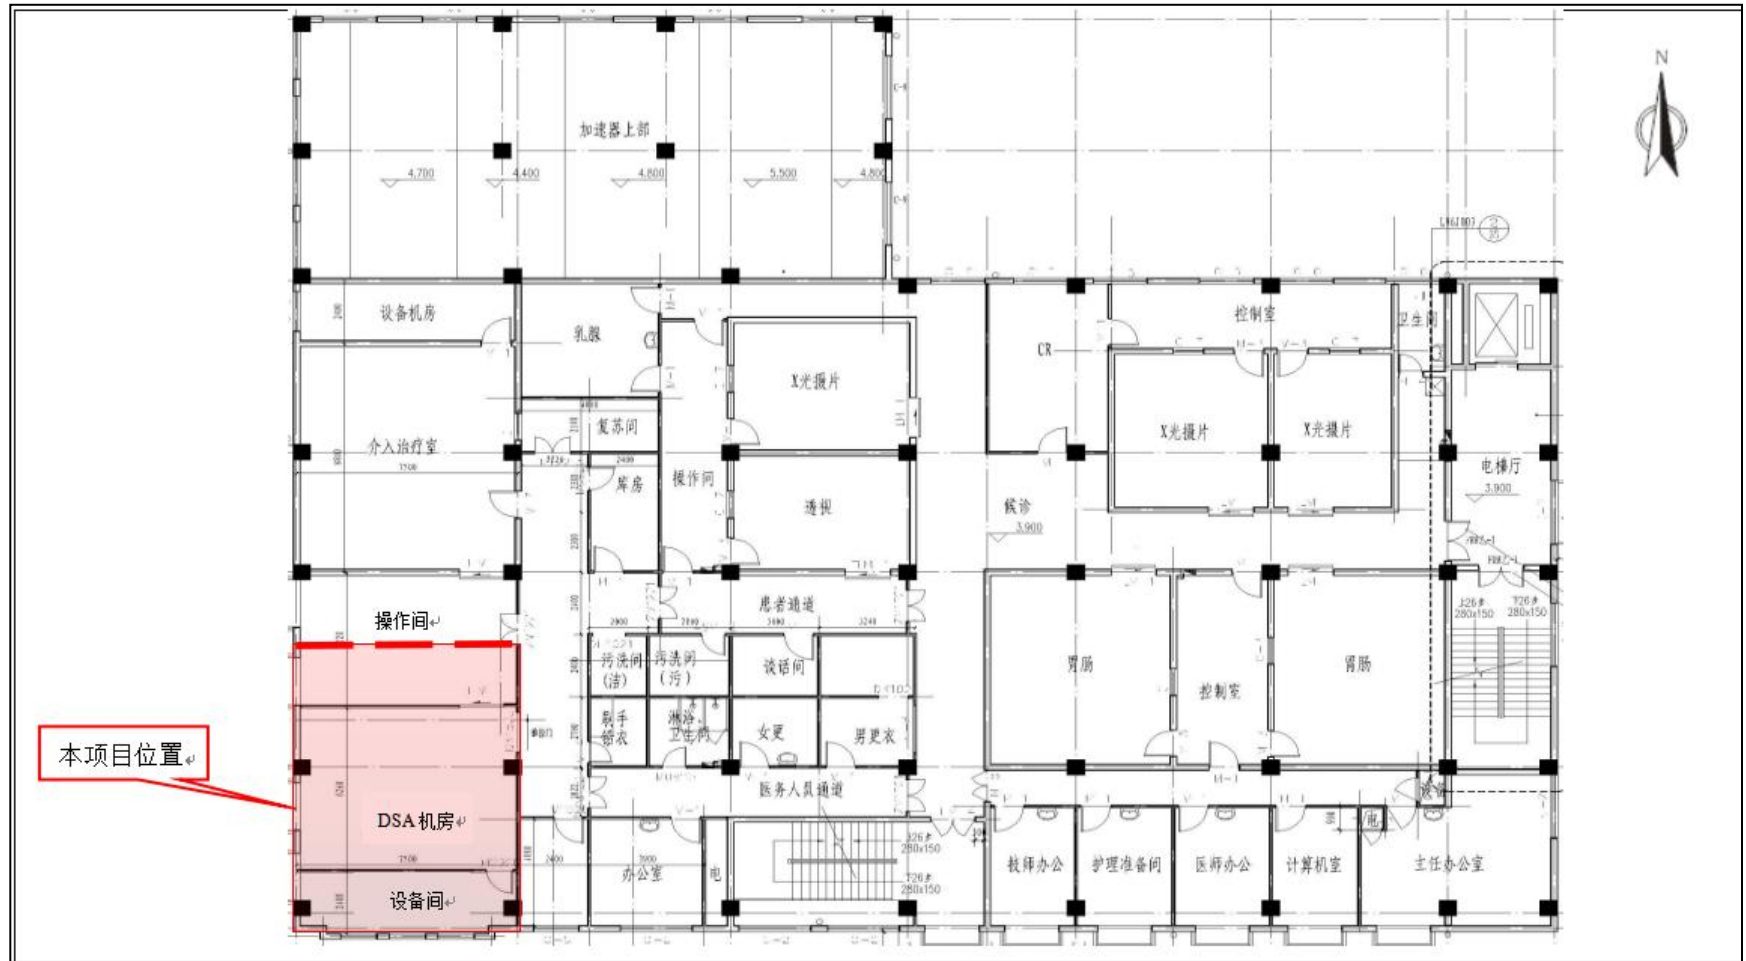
青岛市胶州中心医院综合楼二楼总平面布置示意图
